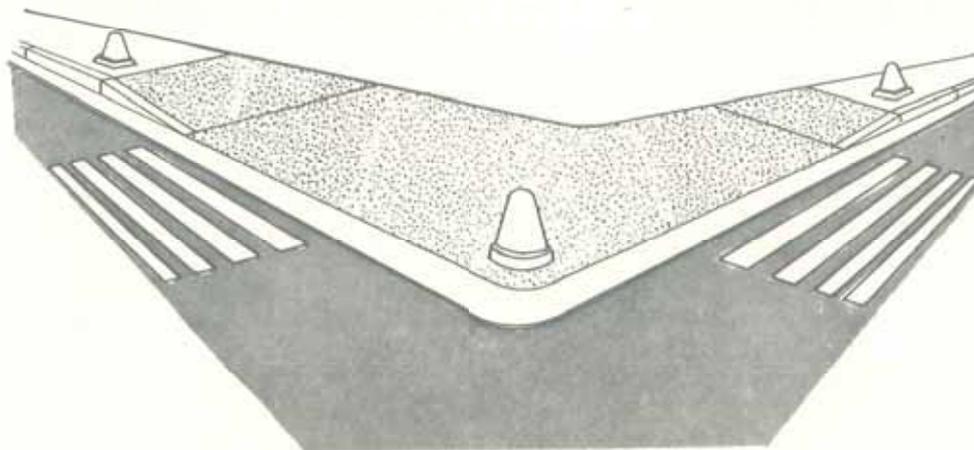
REBAIXAMENTO DE GUIA E CALÇADA
